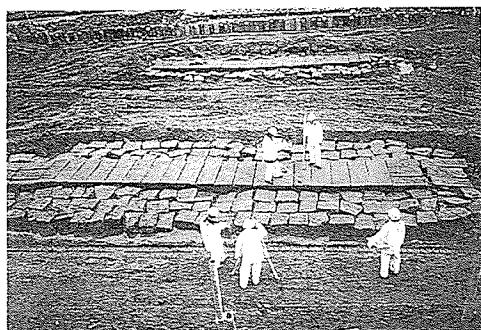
基礎石並びに護床敷石の状況（1, 2連アーチ間部の最も下）
